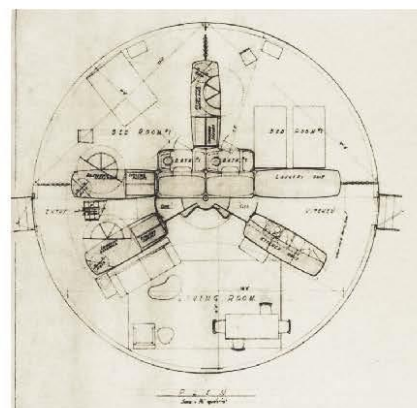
Planta Wichita House, Buckminster Fuller, R., 1945.
